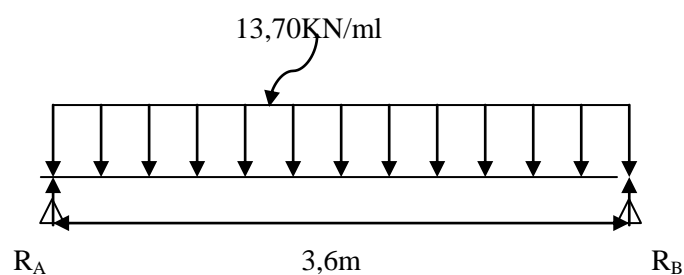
Schéma statique de la poutre palière ELS
